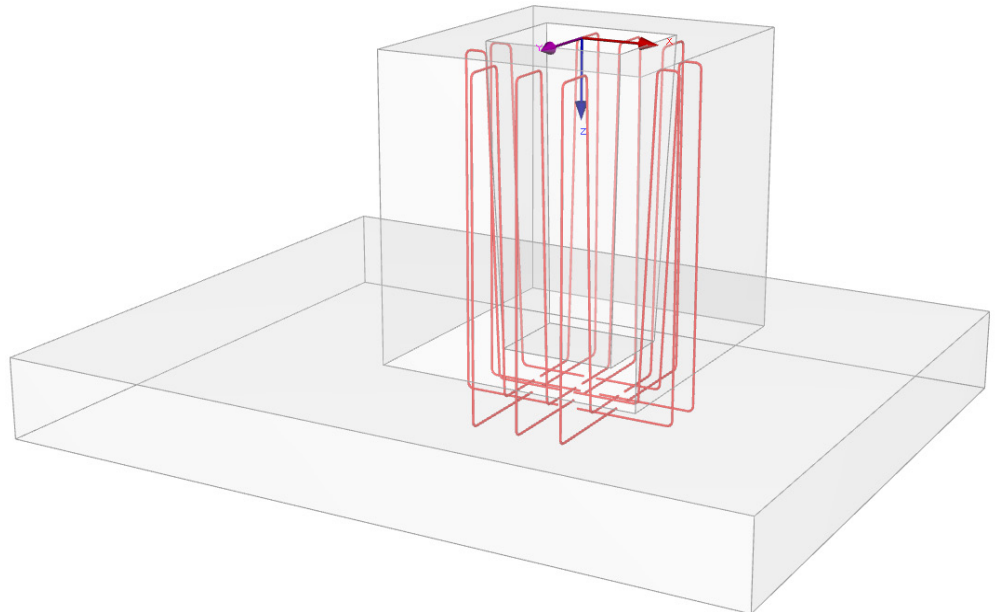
Rendering der Köcherwandbewehrung in x- und y-Richtung
